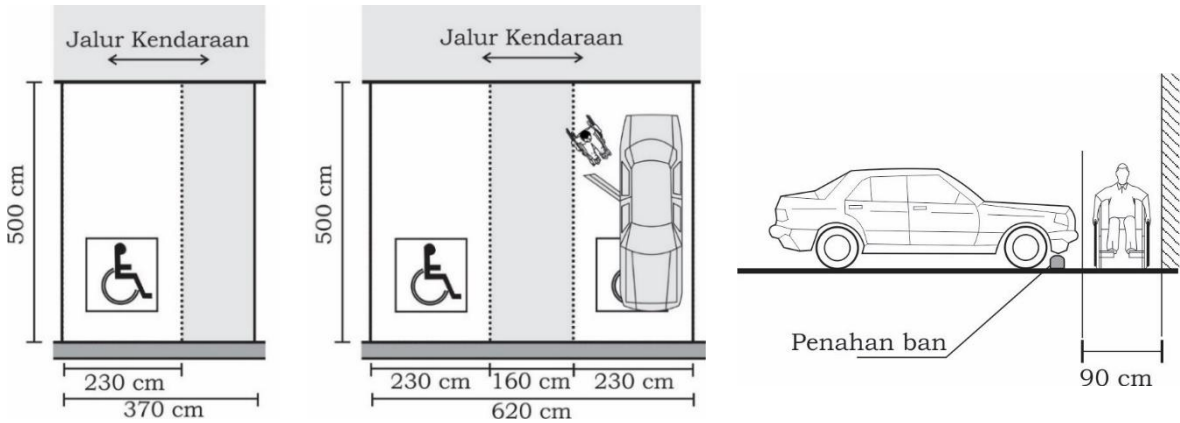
Dimensi ruang parkir dengan sudut 90°
